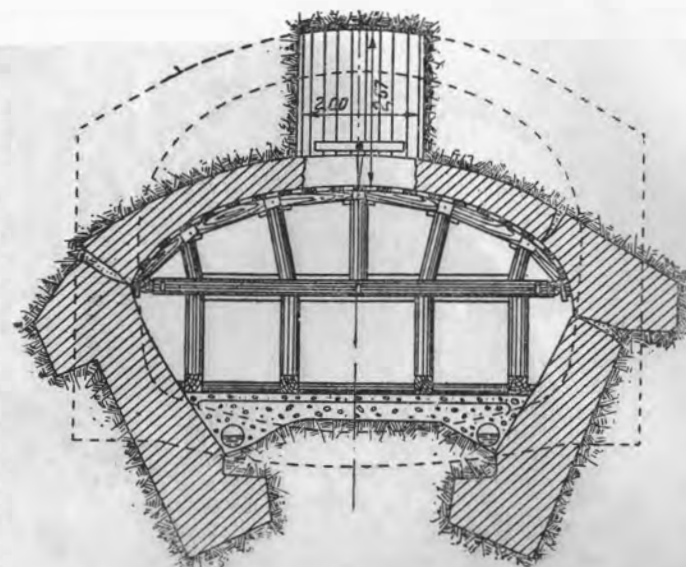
Взятие на временное крепление элементов обрушенной тоннельной обделки в связи с строительной катастрофой под „Авеню Марсо“.
